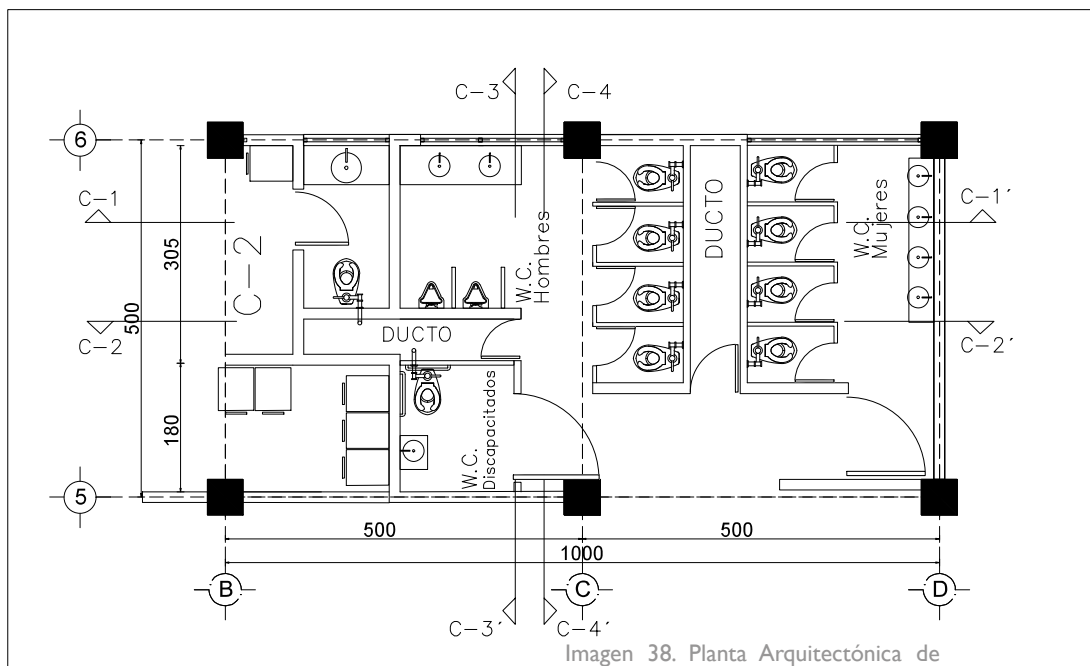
Planta Arquitectónica de detalle sanitario. Elaboración propia
